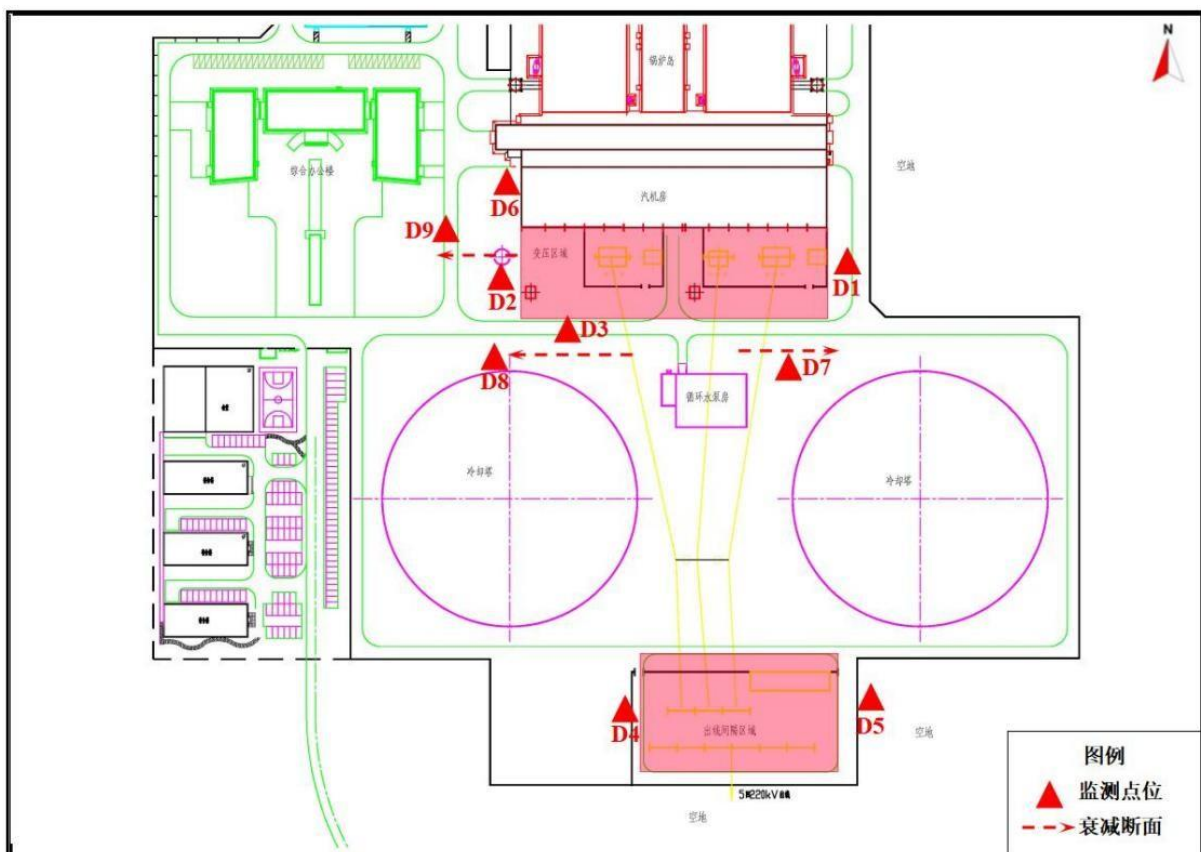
分宜电厂 220kV 升压站监测布点示意图
